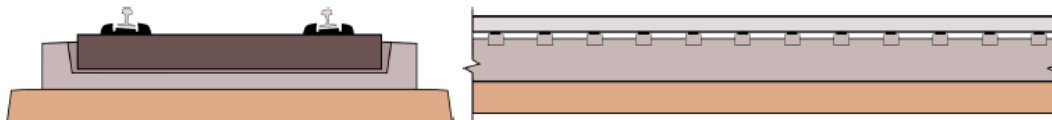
Esquema de la sección transversal y longitudinal de la vía en placa (Rheda 2000)
